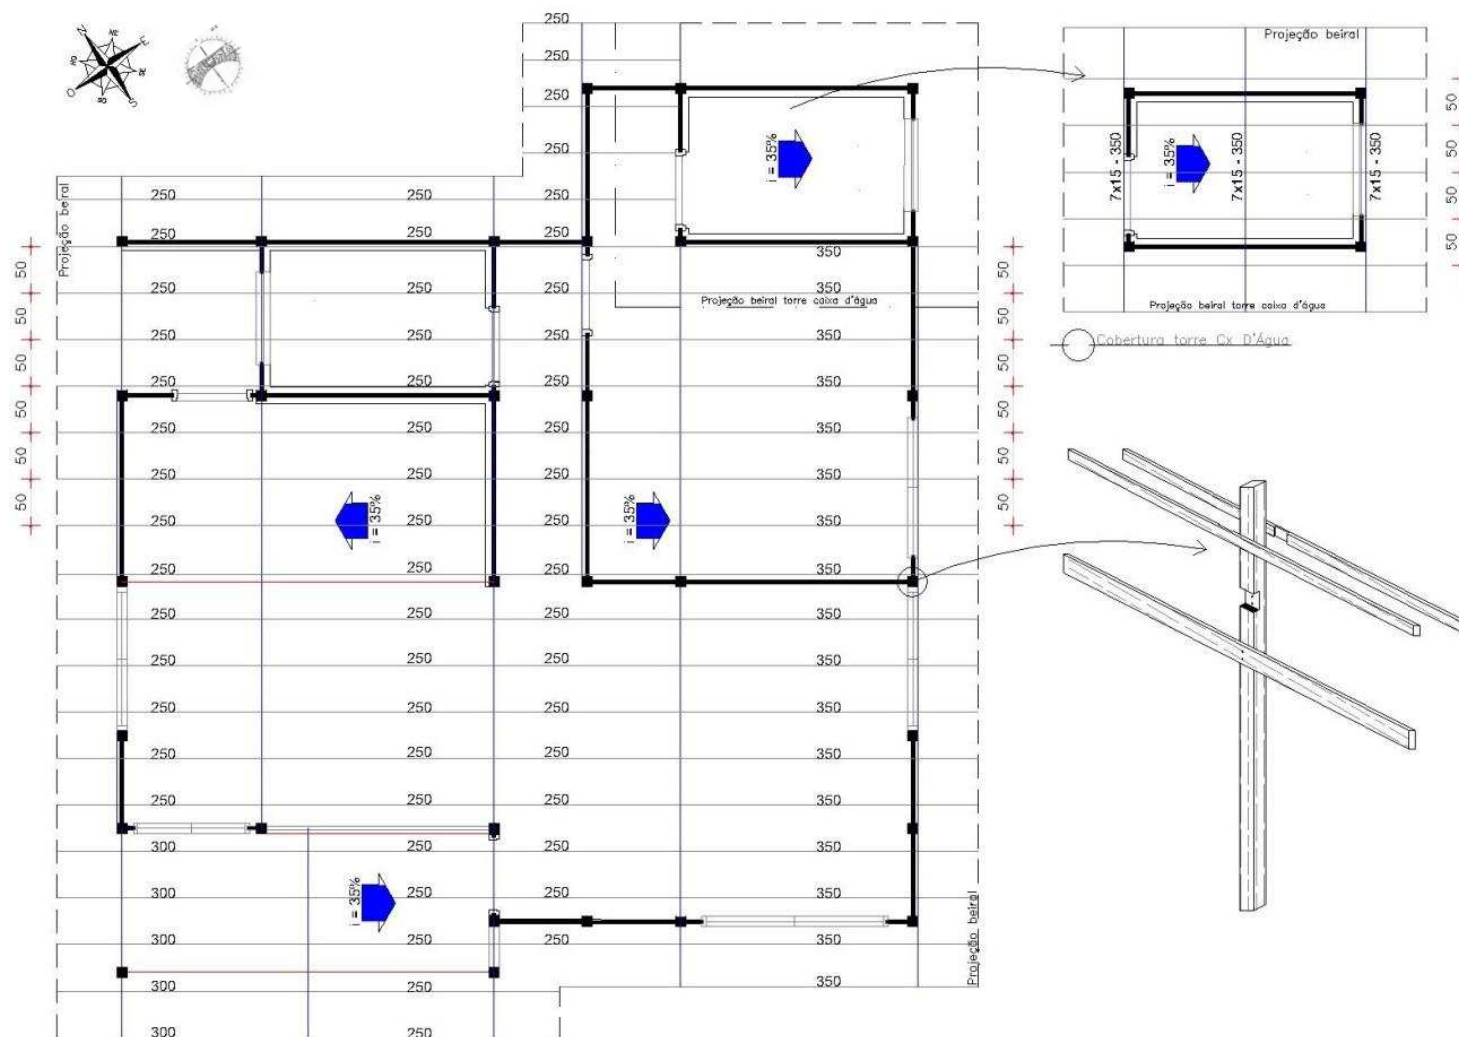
Projeto de montagem dos caibros na cobertura (módulo base).
